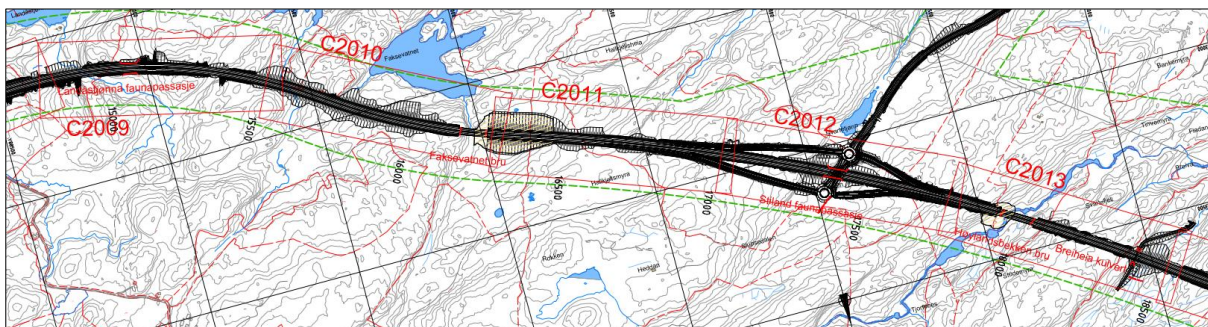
viser strekningen Vallerås kulvert til faunapassasje ived Landåstjønna, inkl. Audnedalen bru
